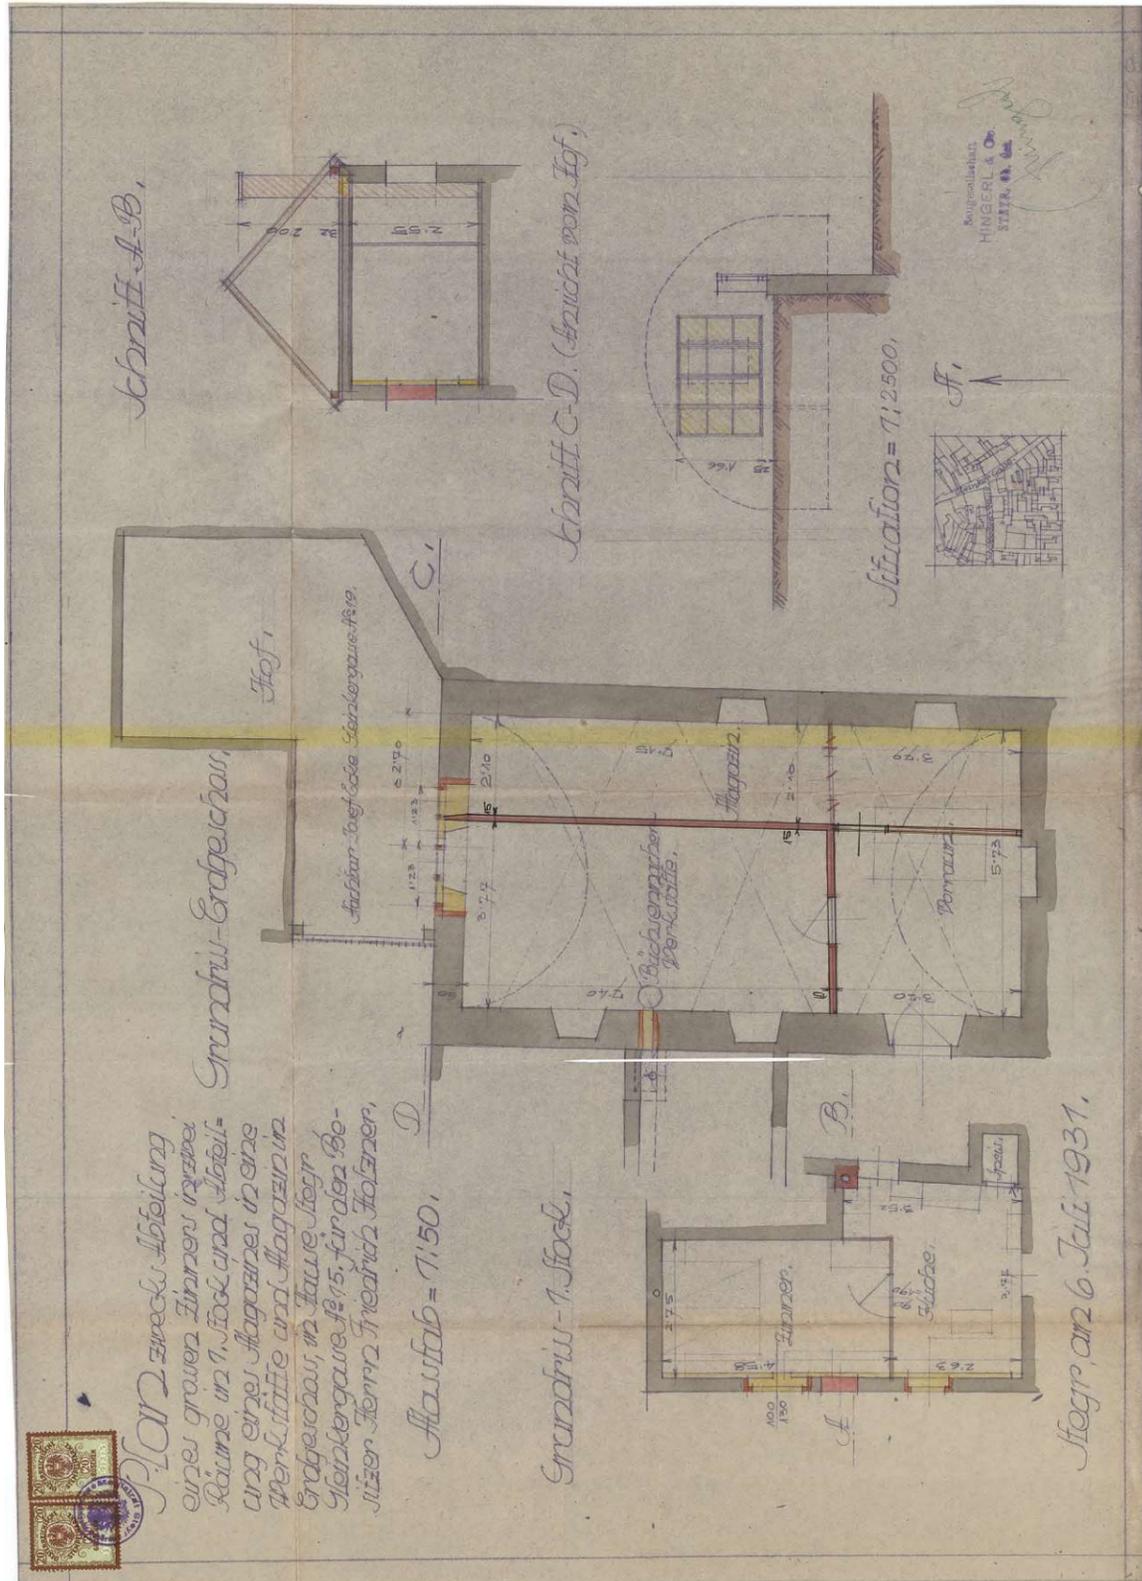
Plan für Umbauten im westlichen Teil des Gebäudes
